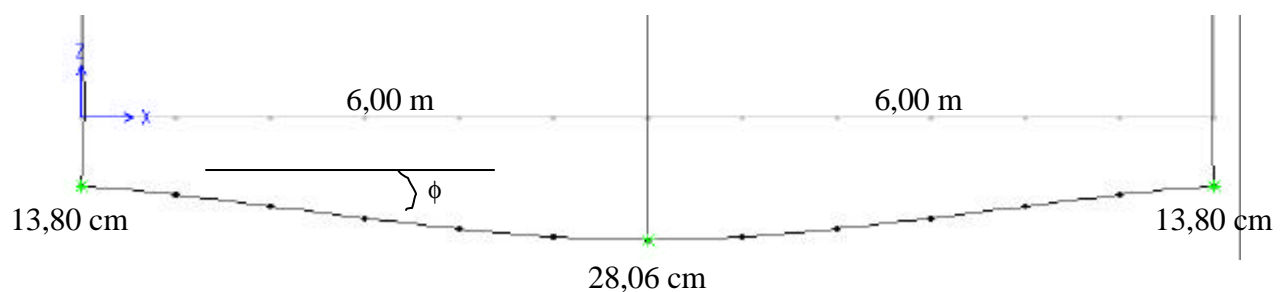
Rotação da viga de fundação do pórtico plano central do modelo que não considera a flexibilidade da fundação.
